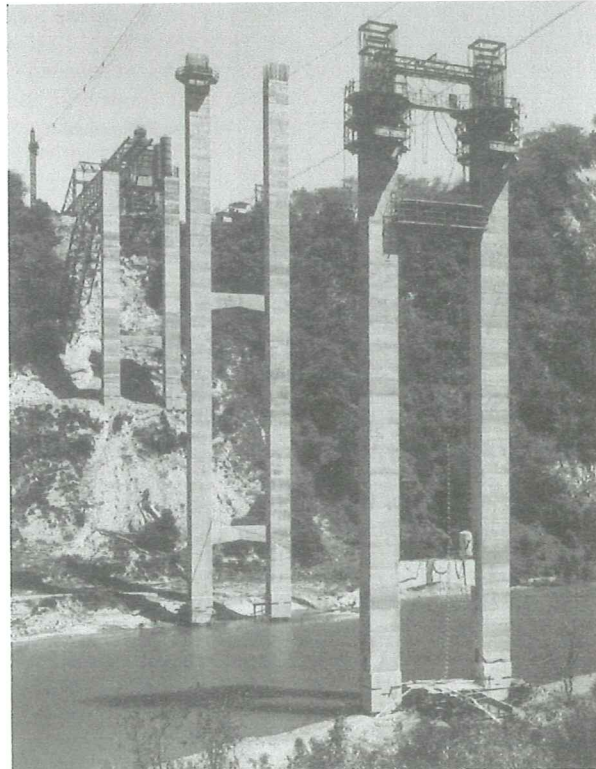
El Viaducto sur Raingitikei fue aislado transversalmente al permitir la rotación de las pilas mediante el desplazamiento vertical de las columnas (Skinner, et al, 1993)
